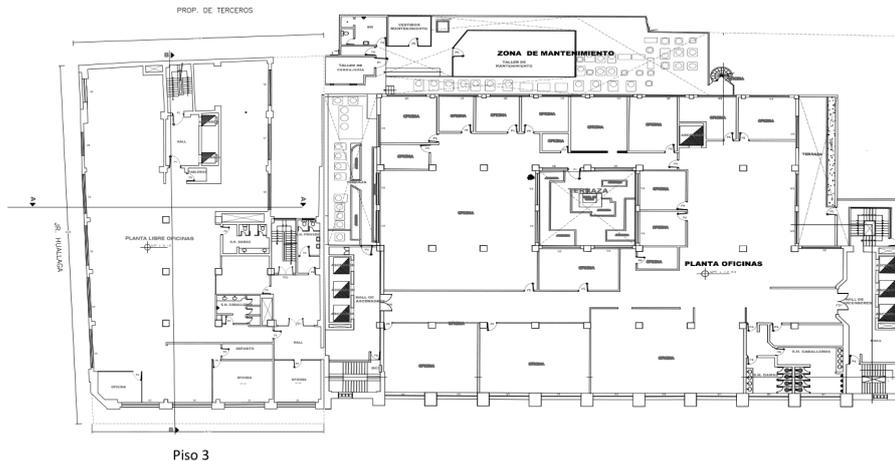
Edificios Melchor Malo y Central, plano 3er nivel. Fuente: Congreso.
